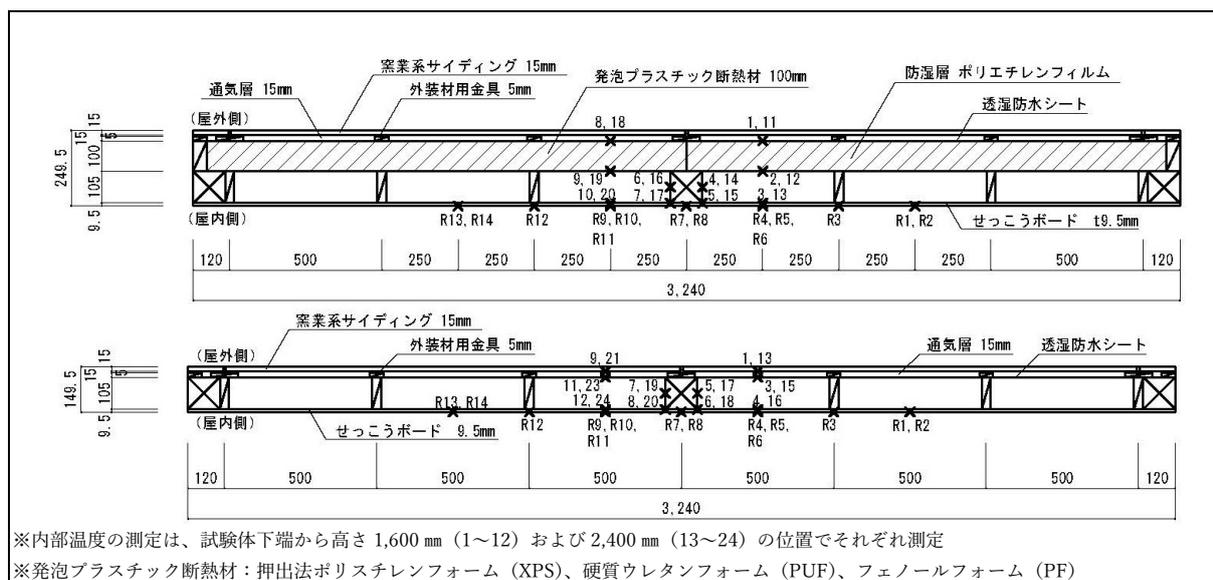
試験体図 水平断面図 (上: 外張断熱工法外壁、下: 無断熱壁体)
